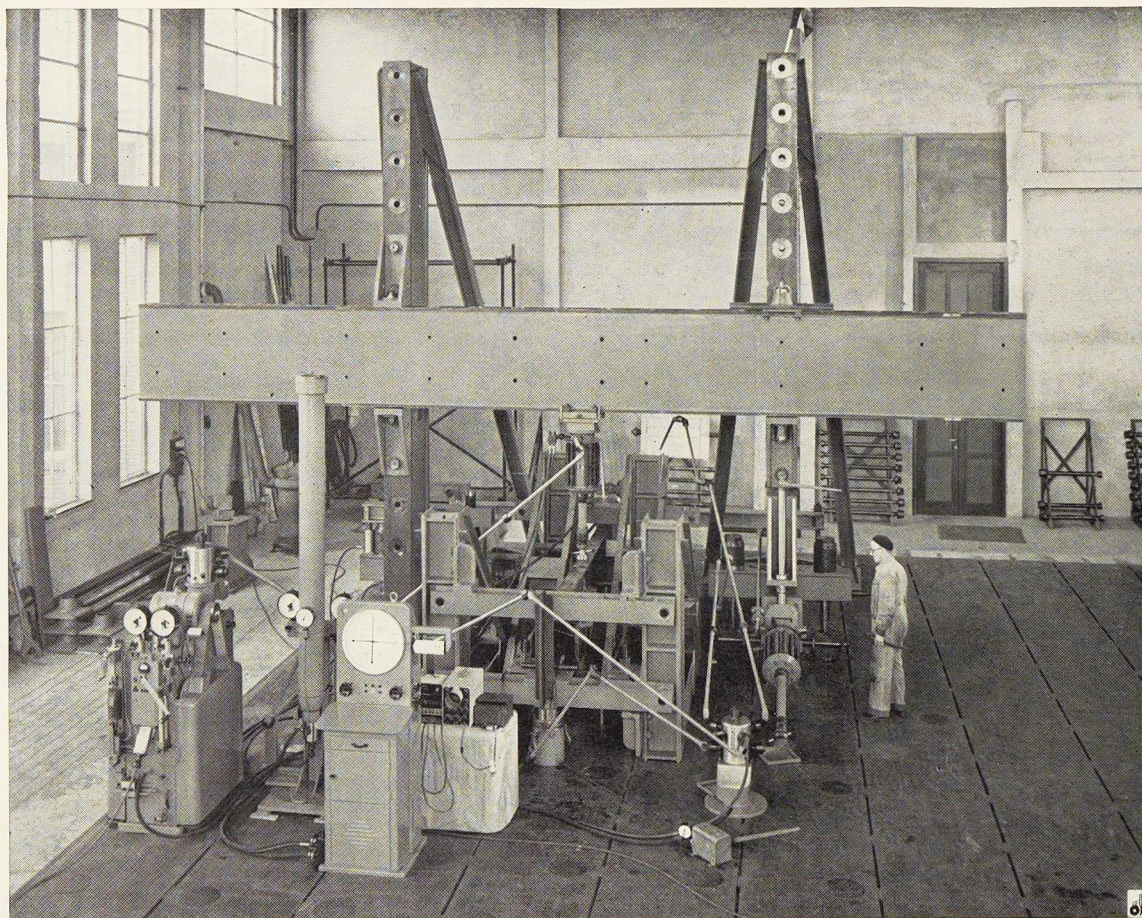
Vue de la partie de l'installation Gimed montée pour l'essai décrit au premier paragraphe (voir aussi fig. 10).
